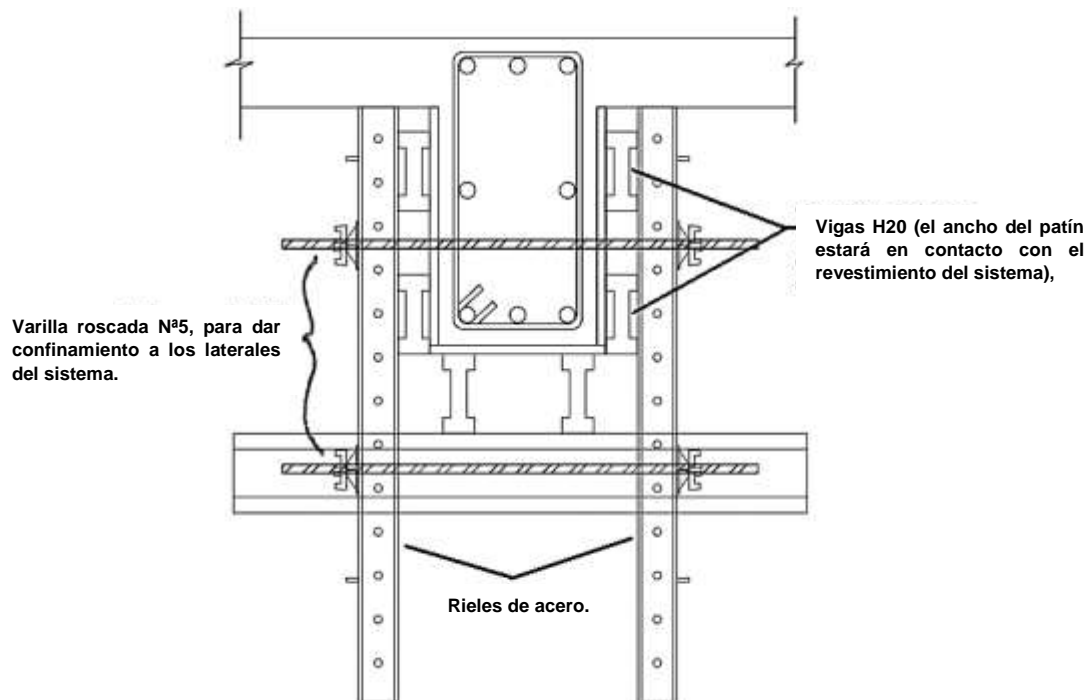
Encofrado de vigas de concreto mediante el sistema de vigas H20. Reyes, [Ilustraciones de encofrados, varias], (2020).
